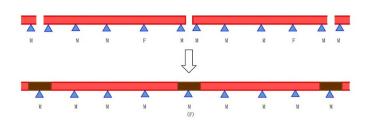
連続化イメージ図 Figure 2 Concept of continuous floor framing girder
